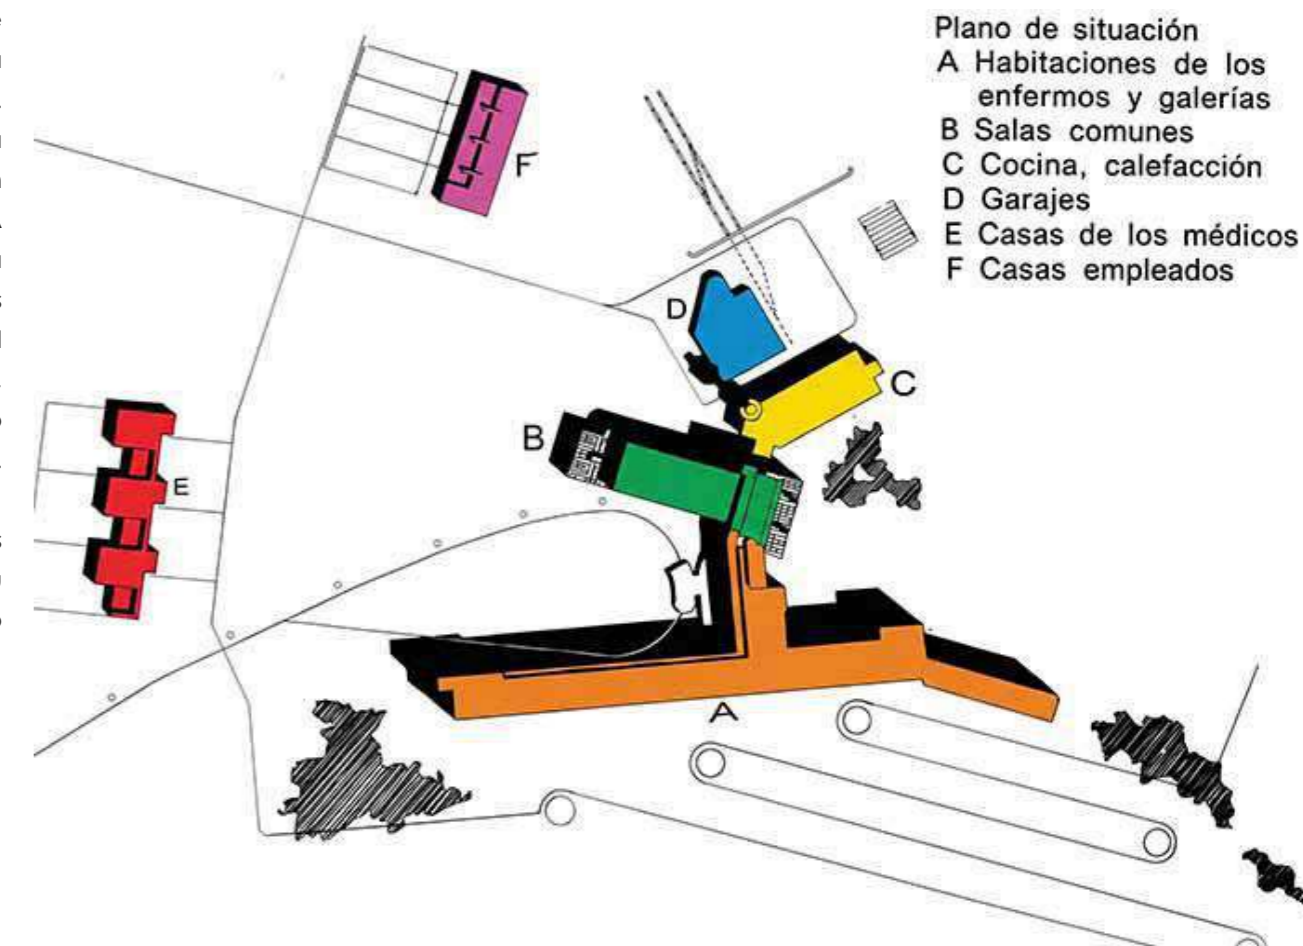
Plano de situación del Sanatorio Paimio. Elaboración: Aalto (1929)
